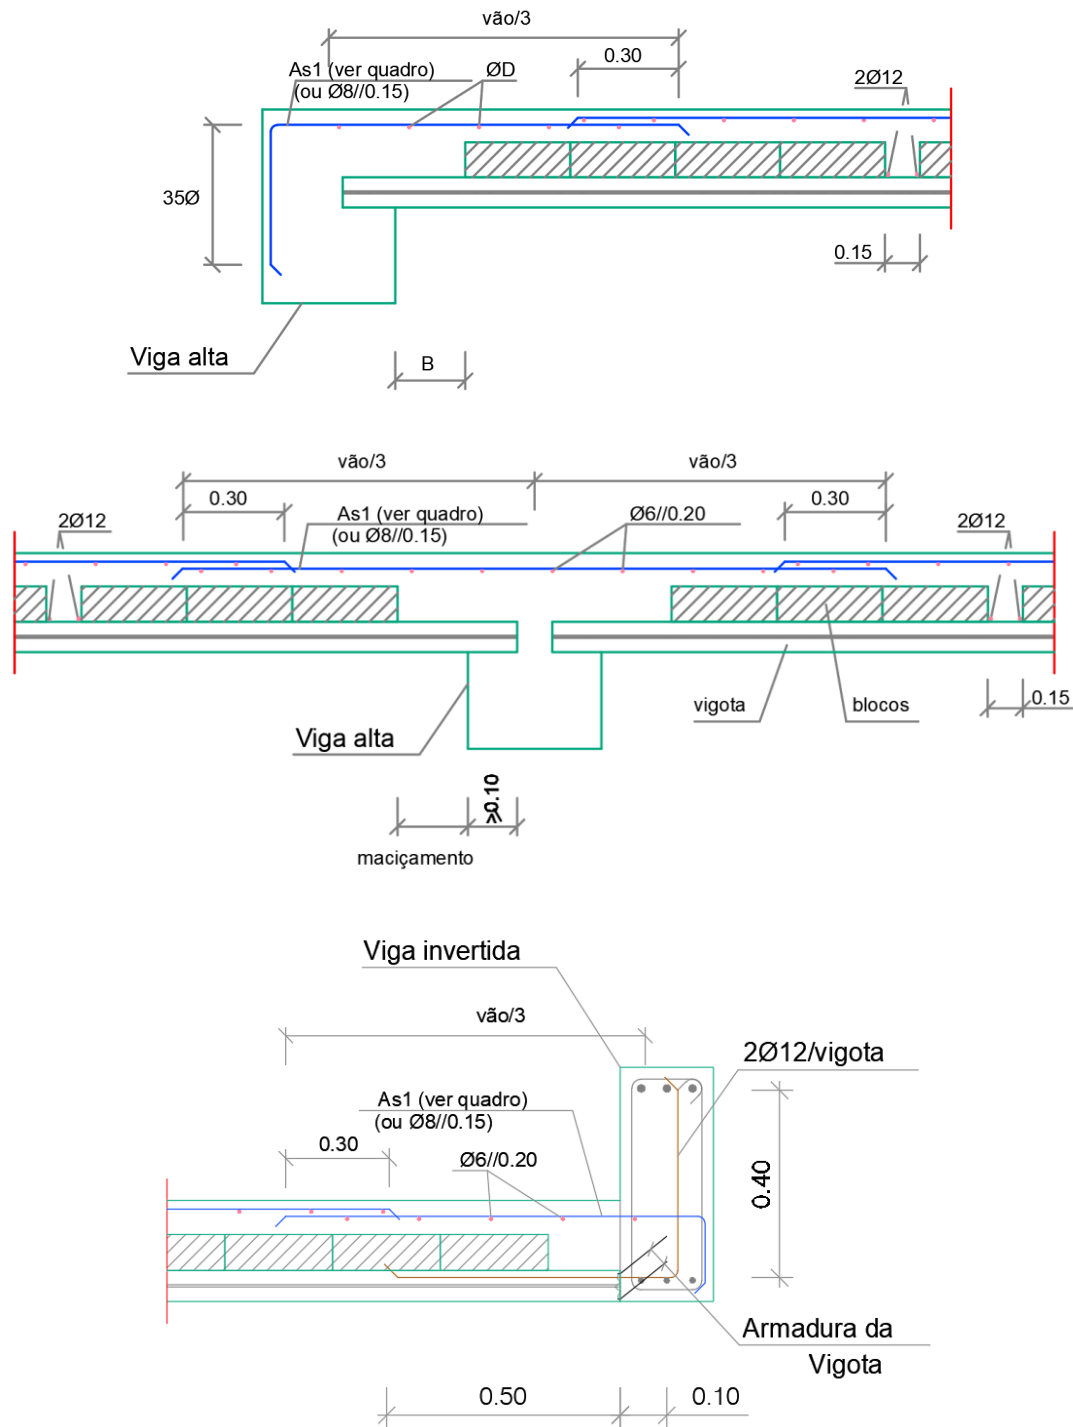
Pormenor de armaduras de lajes aligeiradas (Projeto de estruturas).
